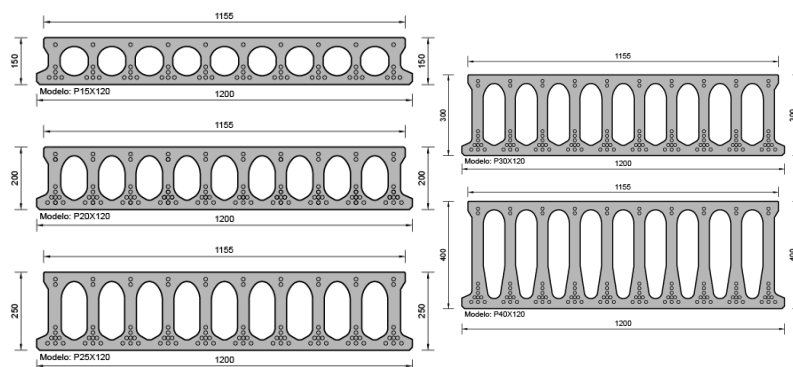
Placas alveolares. Fuente: www.prefabricadosaljema.com
